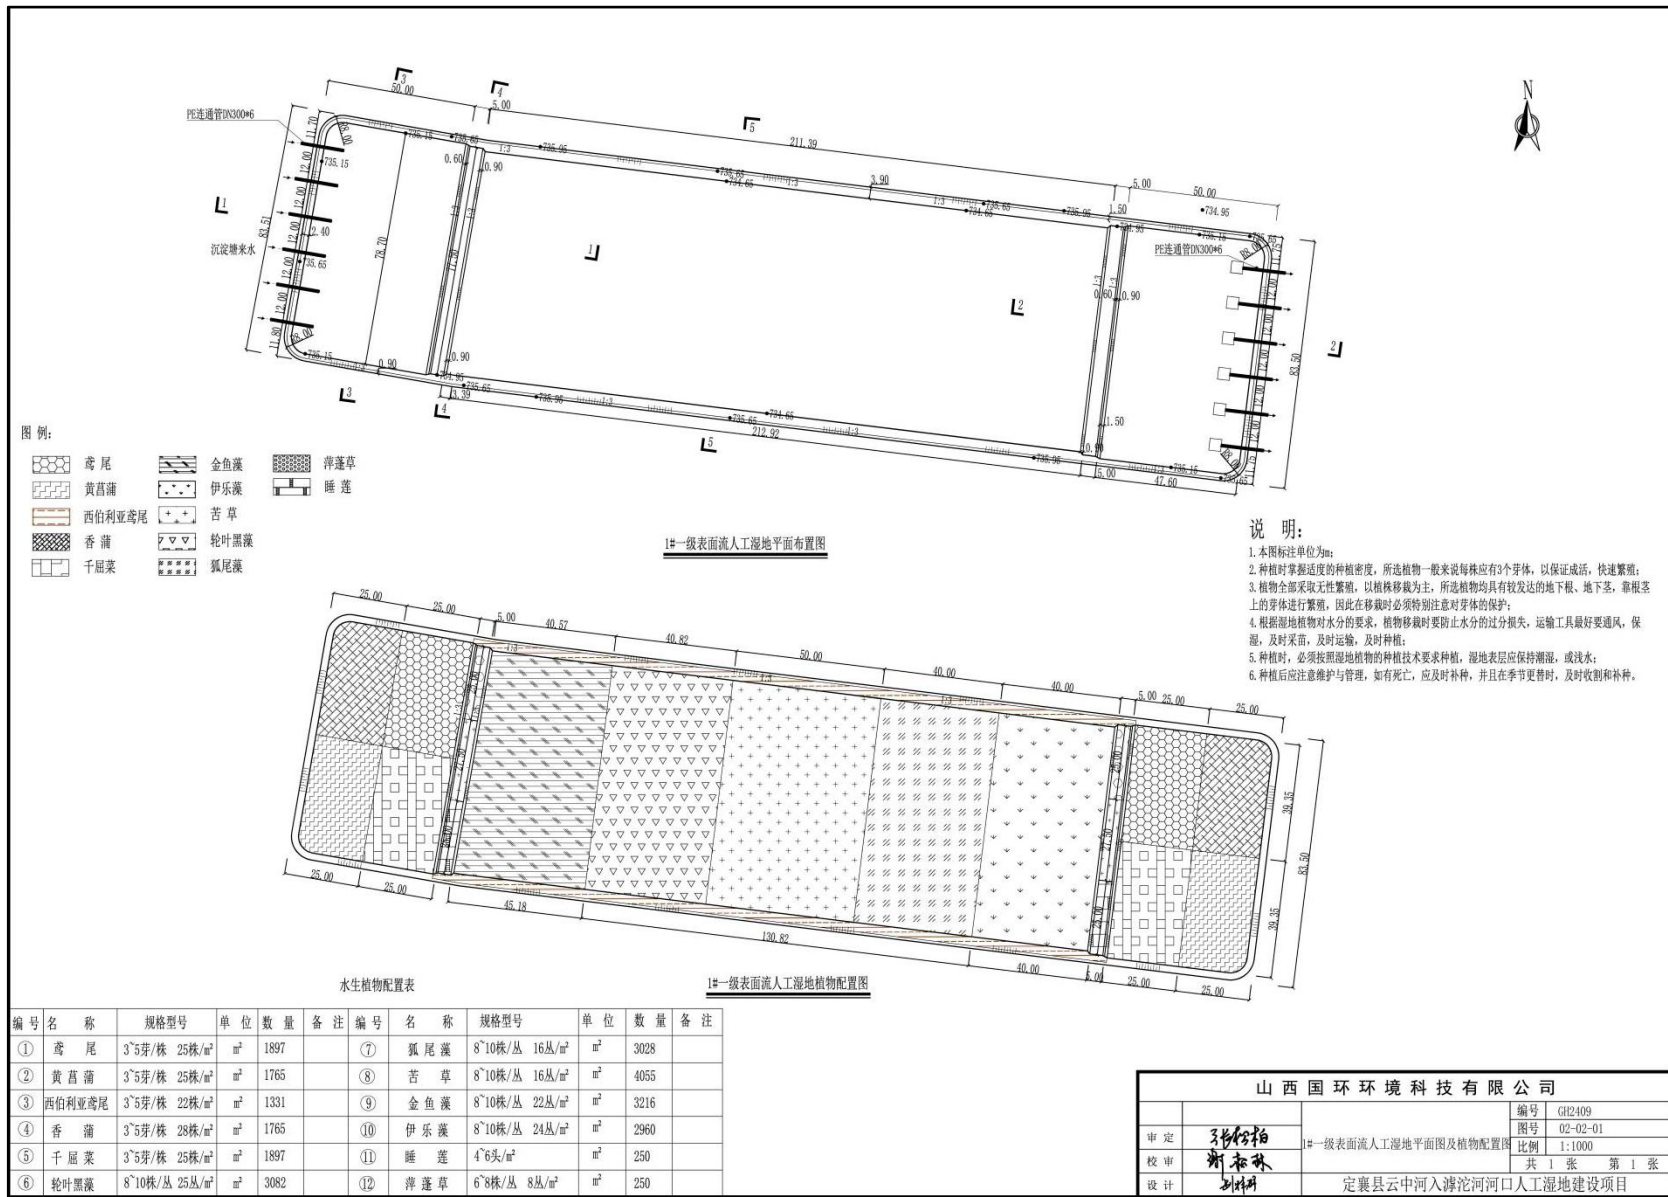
1#一级表面流人工湿地平面布置及植物配置图
